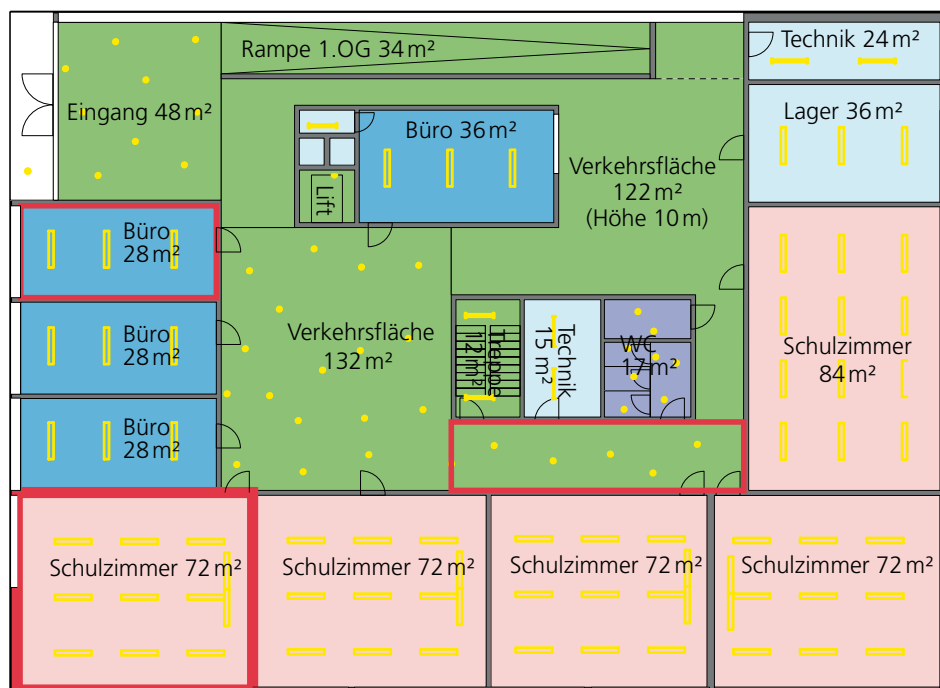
Grundriss eines Schulhauses mit markierten Nutzungen und typischen Räumen.
